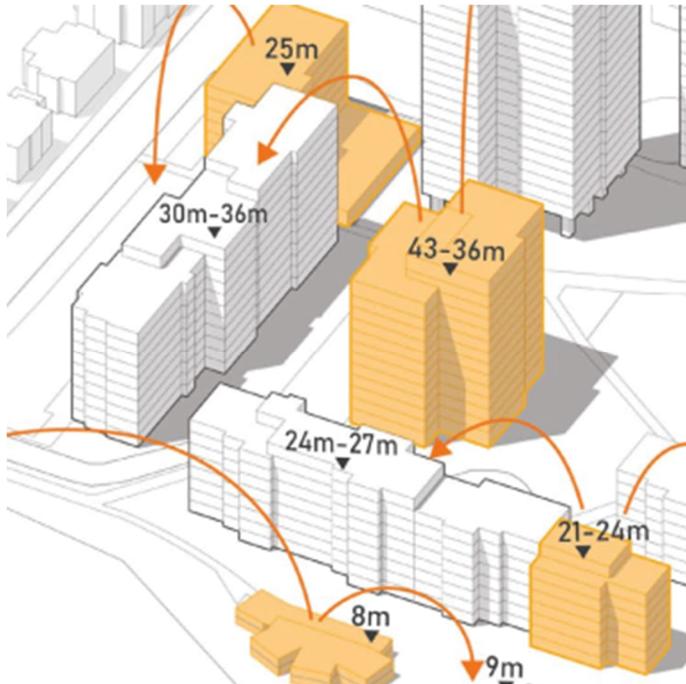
Hochhaus N4, 12- bis 14-stöckig, im Bereich Goltstein-/Berndorffstr. Quelle: Planungsossier in Vorlage 3705/2023 der Verwaltung der Stadt Köln
